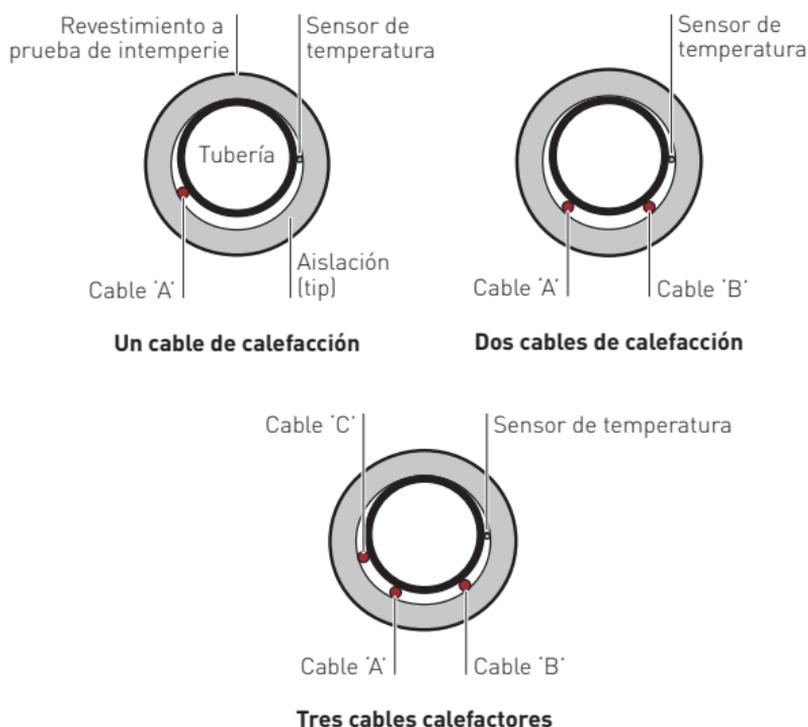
Sección transversal típica de colocación de los cables calefactores SC
